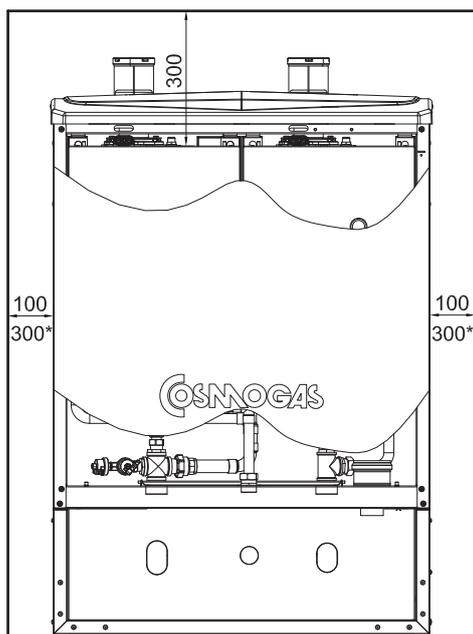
Distanze minime di rispetto DUALDENS T
